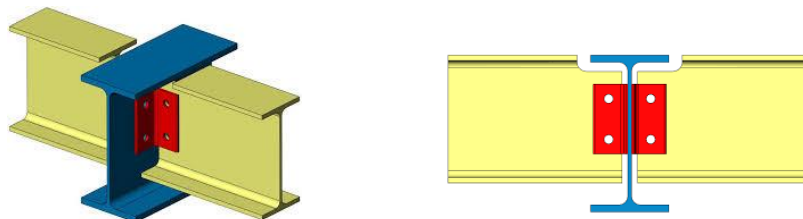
Schéma de l'assemblage poutre – solive.
